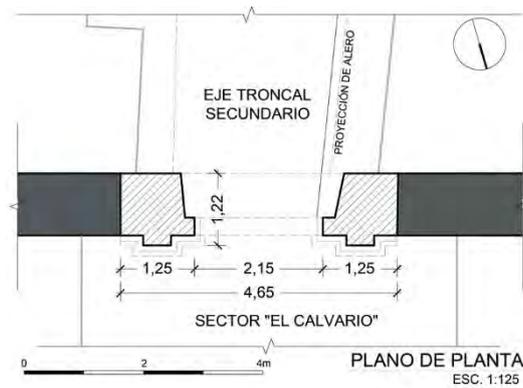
Plano de planta de la puerta-umbral noreste hacia el lado de “El Calvario”. Elaboración propia
